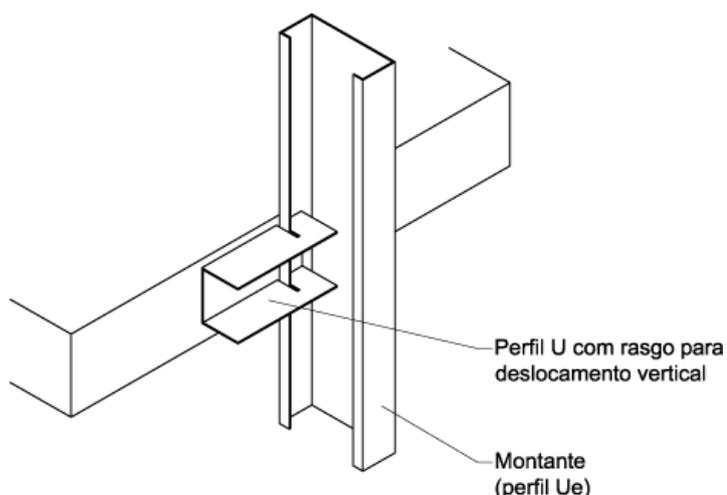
Ligação com perfil U apoiado na mesa e enrijecedor do montante
